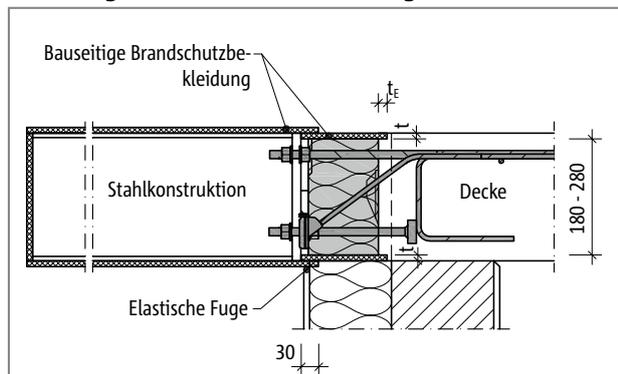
Schöck Isokorb® XT Typ SK: Bauseitige Brandschutzbekleidung für den Isokorb® und die Stahlkonstruktion; Schnitt
